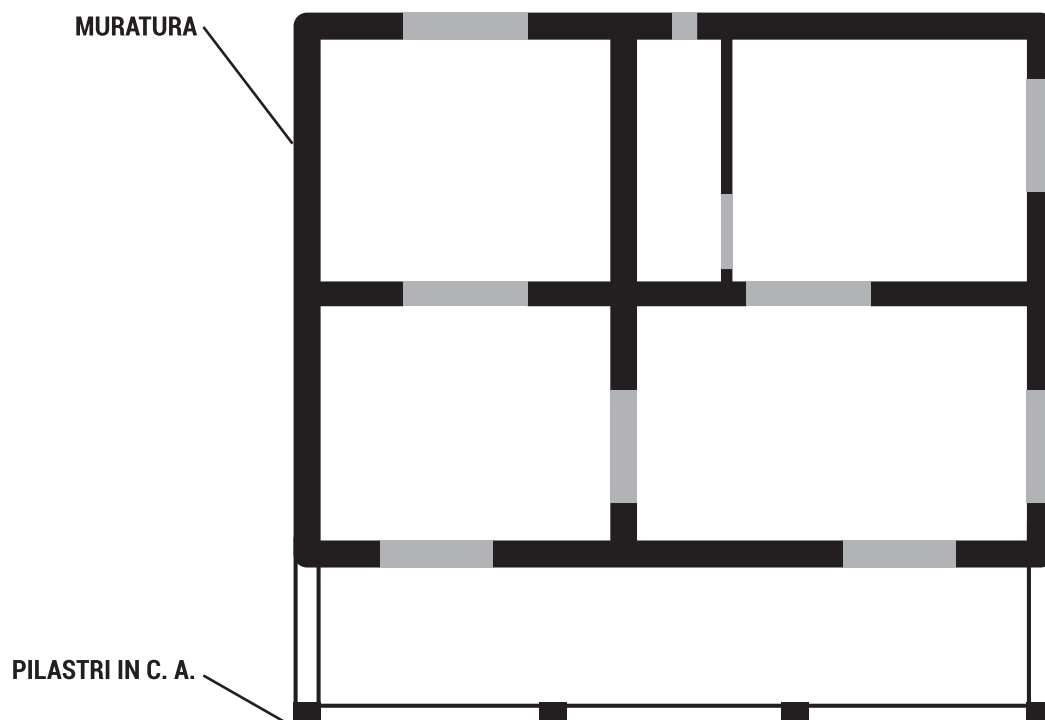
Esempio di struttura mista con muratura perimetrale e pilastri esterni.
